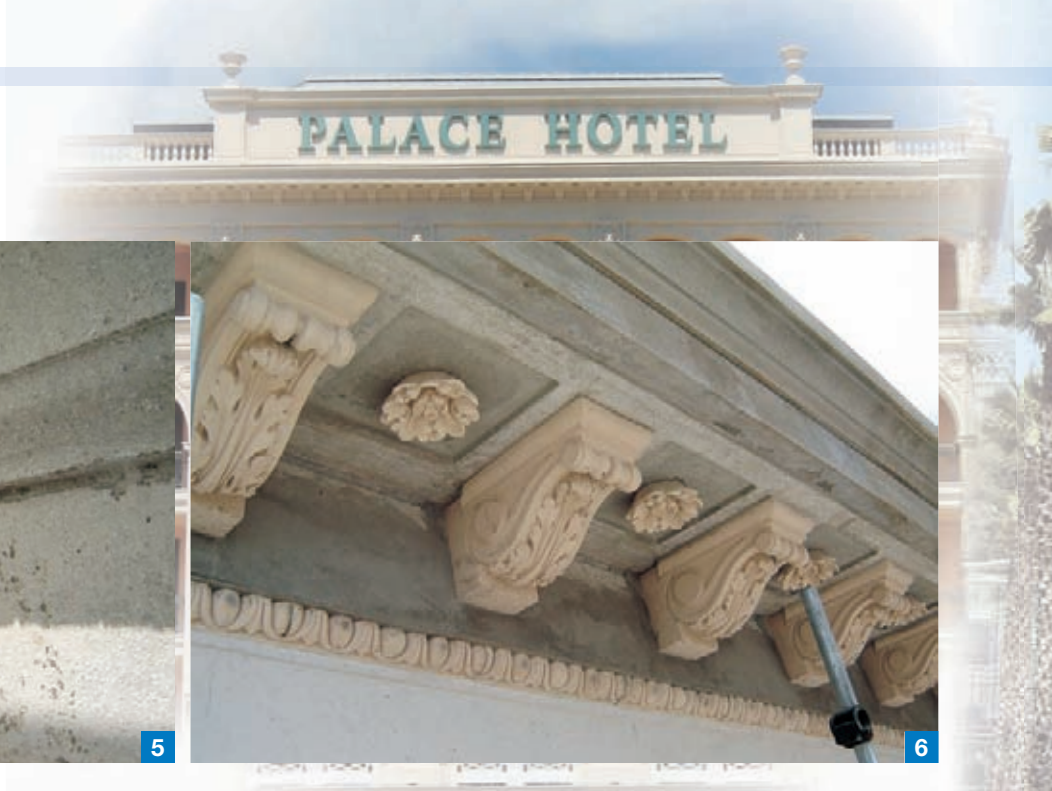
Stesura di PLANITOP 400 sulla cornice in calcestruzzo.
